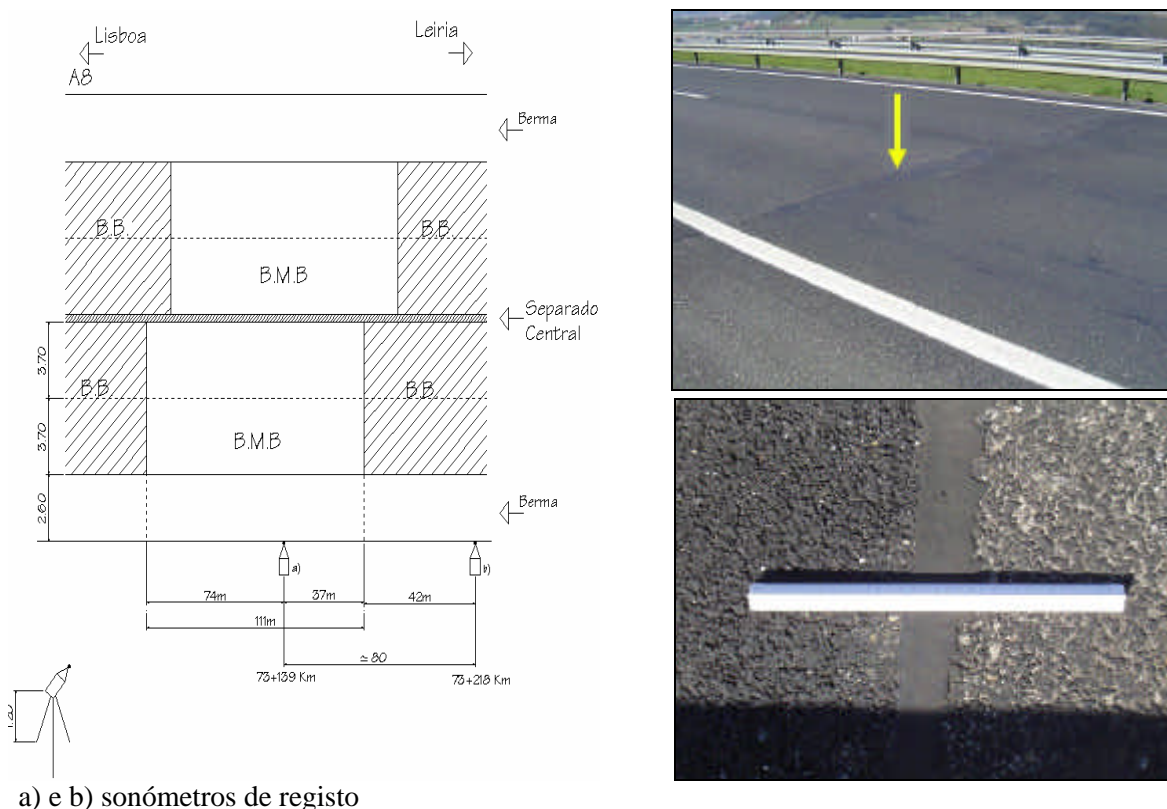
Esquema do ensaio e pormenor da transição entre os dois tipos de pavimento BMB / BB
